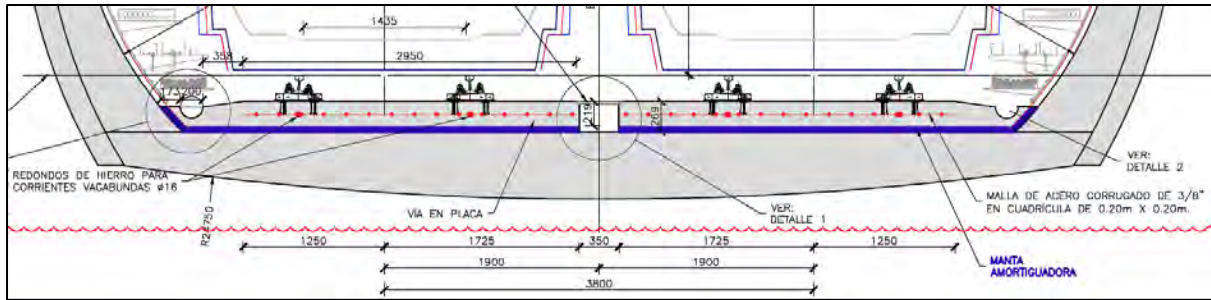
Detalle Vía en Placa. Sección con Manta Amortiguadora
